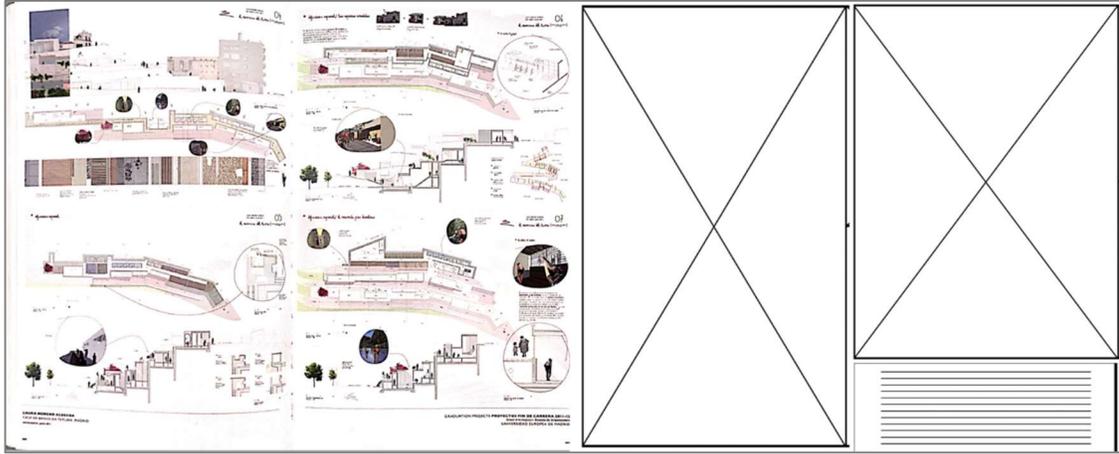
Layout de Paneles Múltiples Aplicado EN TRÁNSITO IV.
